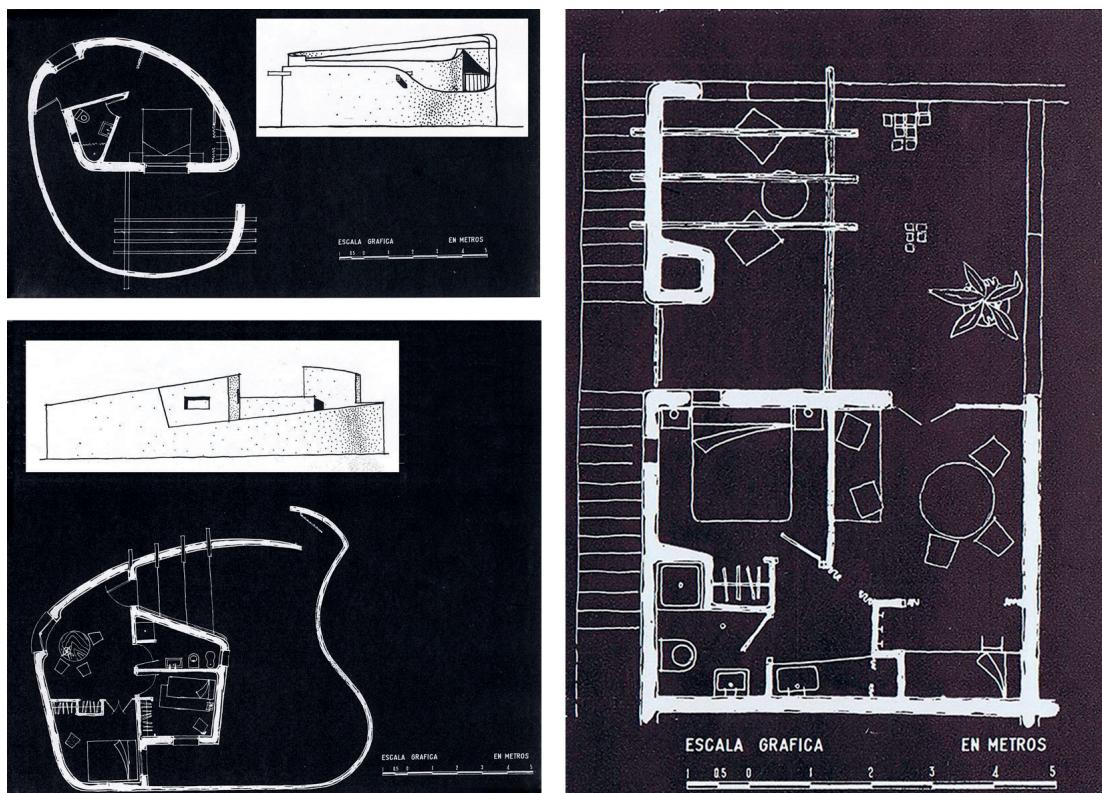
Arriba Izquierda: "Alzado y planta del hotel Tipo A". Proyecto original (1956). Abajo Izquierda: "Planta y alzado del hotel Tipo B". Proyecto original (1956). Derecha: "Planta del hotel Tipo C". Proyecto original (1956).
